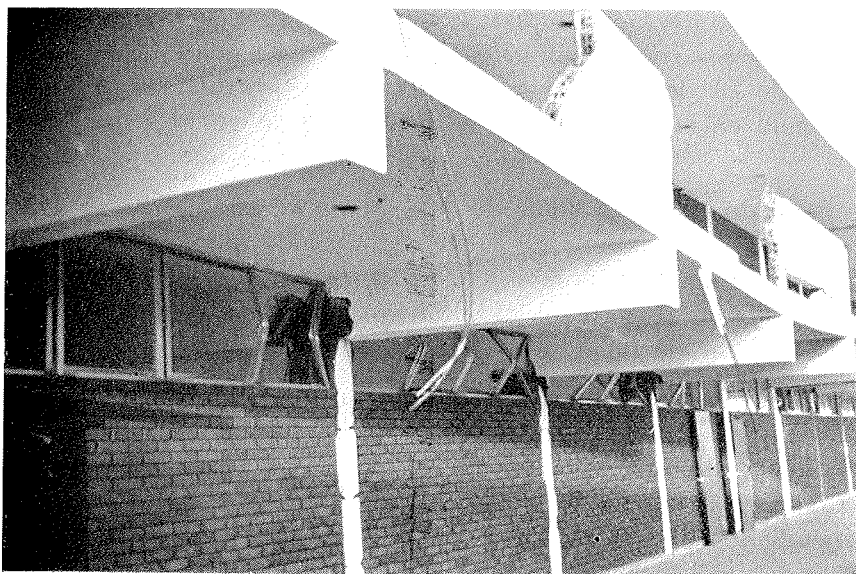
Otro caso de columna "corta", empeorado por la acción destructora propia de la libre vibración del voladizo. Nótese además los parapetos del segundo piso, contruidos en ladrillo sin contar con refuerzo alguno. Chimbote (Perú), sismo 1970.
